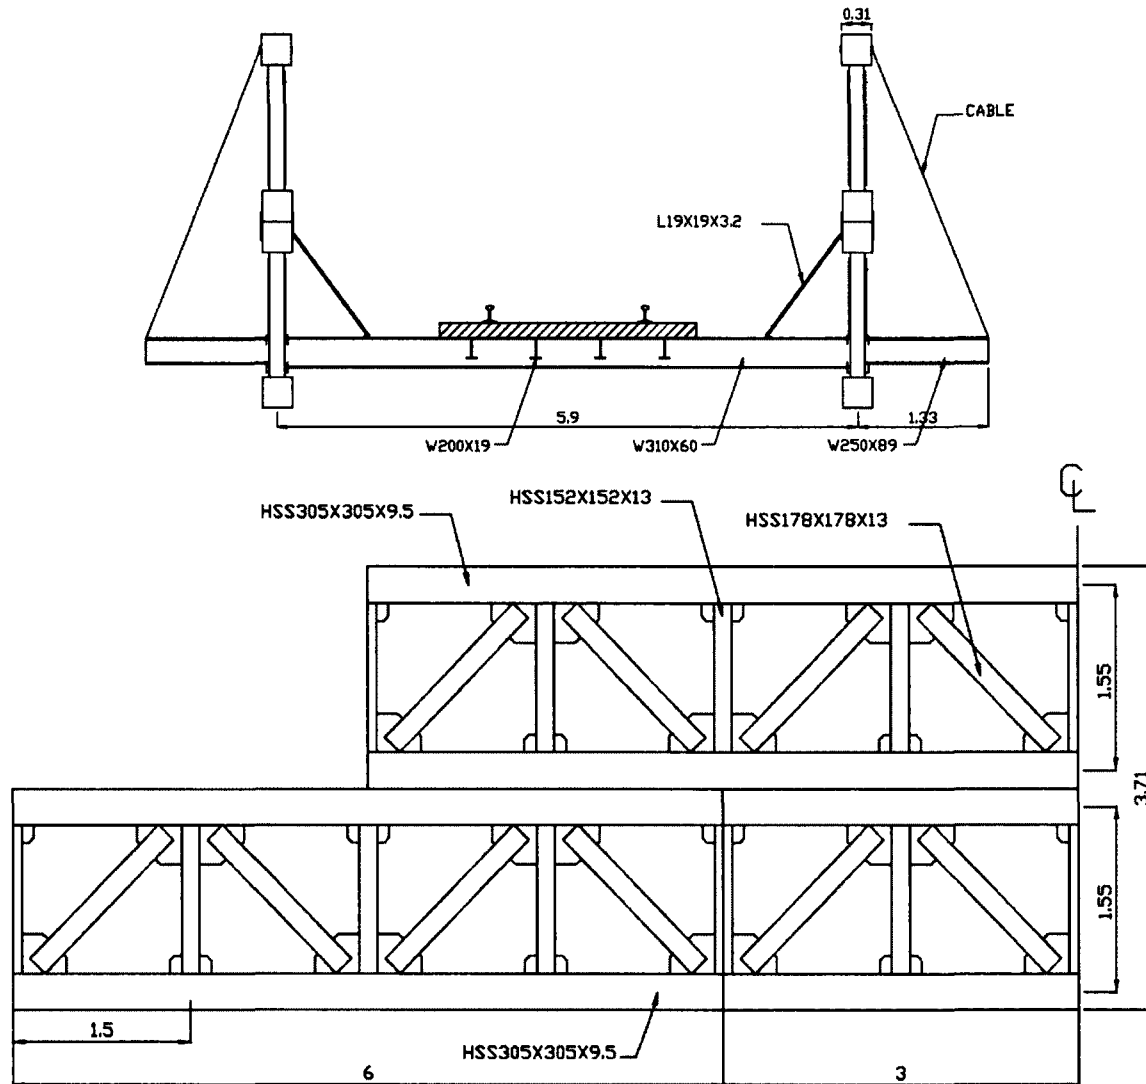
Pont à treillis latéraux - Section et élévation - Section B-B
